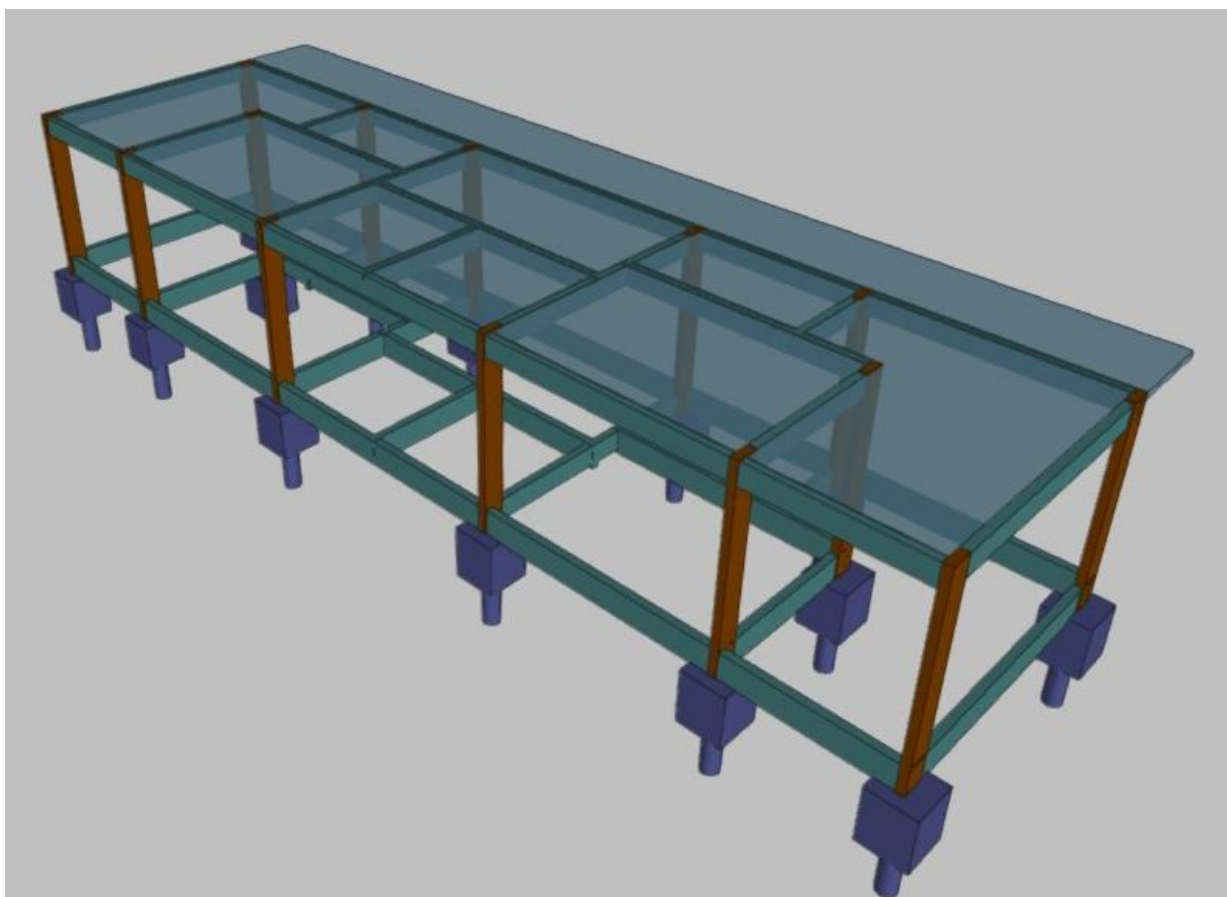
Vestiário – Modelo estrutural 3D vista 1
